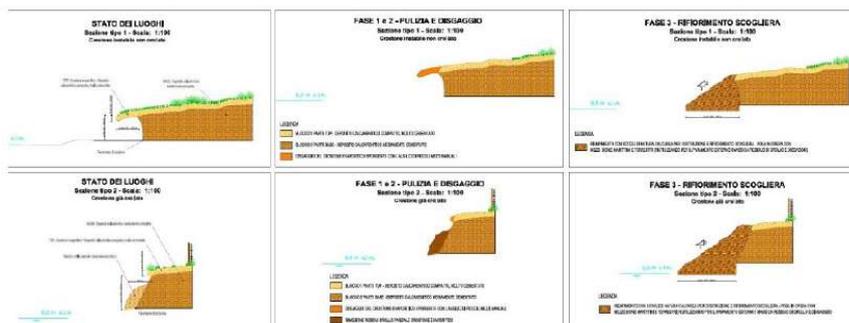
Particolari e schematizzazione delle fasi di intervento (da “T06_Planimetria generale di progetto”)
